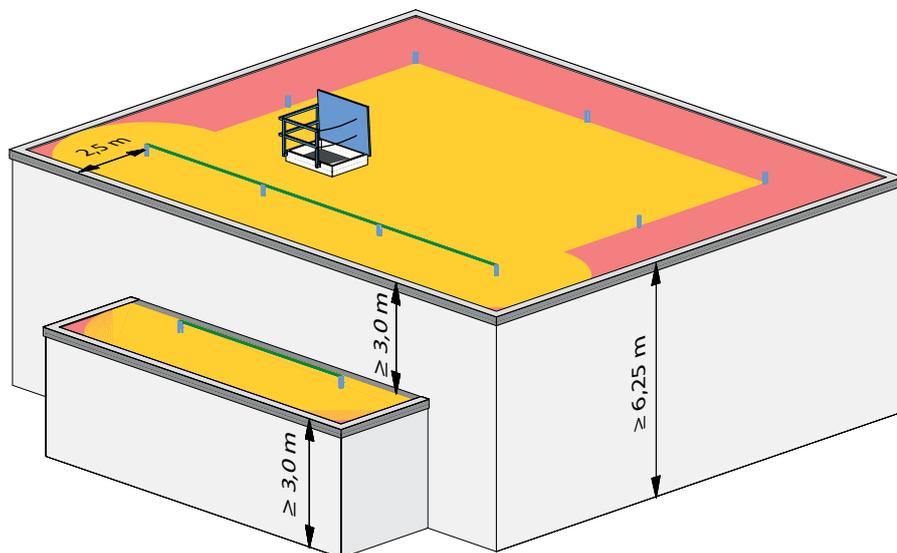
Exemple avec terrasse en attique ou bâtiment avec annexe. Installation des classes d'équipement 1 et 2. Avec un espace de chute de moins de 6,25 m, la classe d'équipement 2 doit être exécutée. Exécution avec dispositif d'ancrage fixe ou temporaire.
